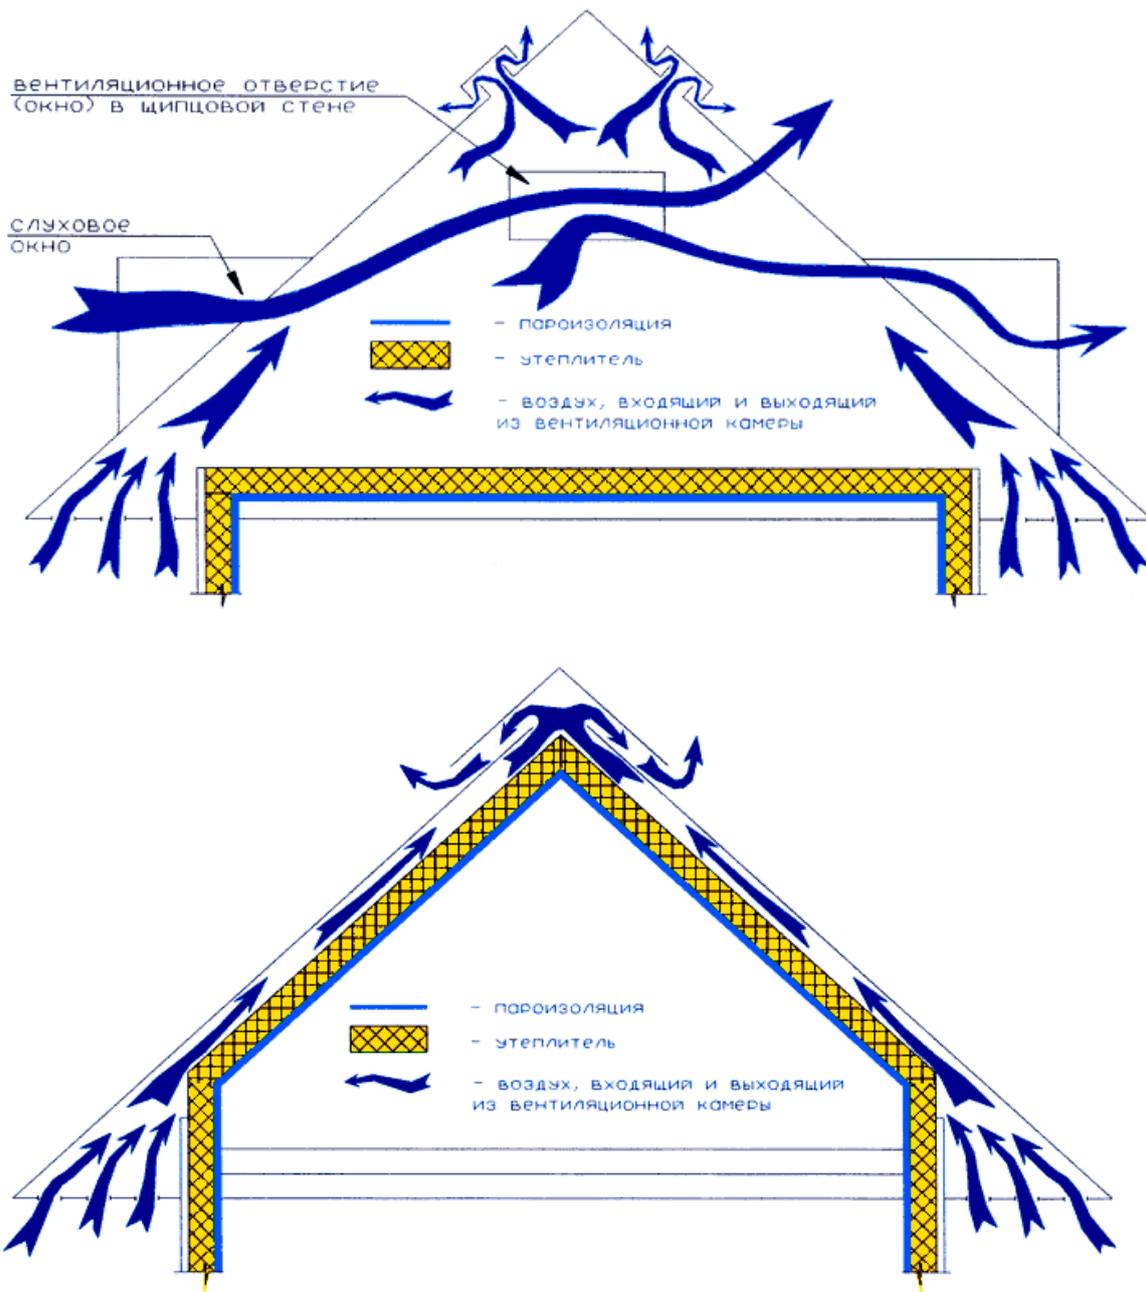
Схемы вентиляции чердачного перекрытия и мансарды
